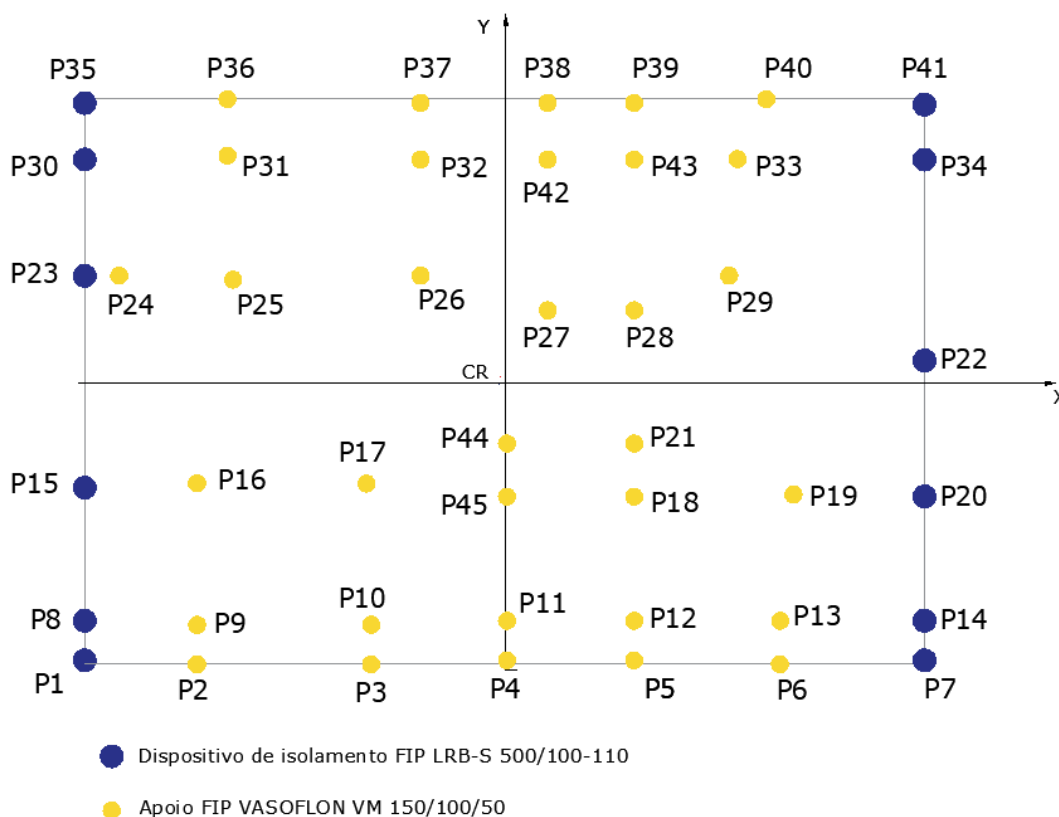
Nova configuração da distribuição dos dispositivos de apoio em planta.
